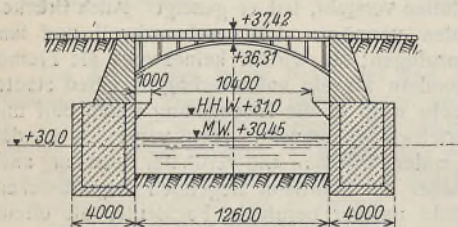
Die alte Königsdammbrücke am Berliner Westhafen. Erbaut 1874.
